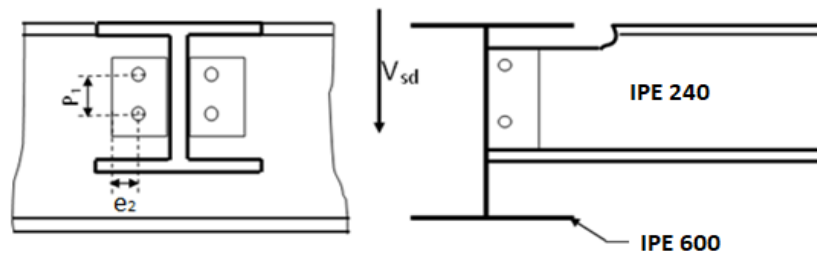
4: Detail de l'assemblage poutre maîtresse-solive
